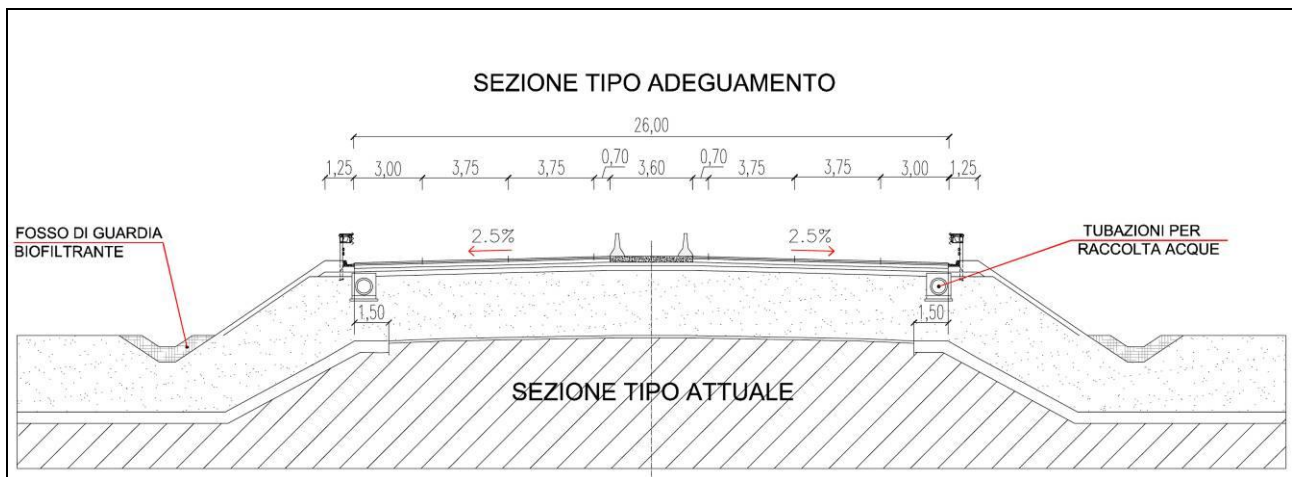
/1 Sezione tipo adeguamento autostrada
